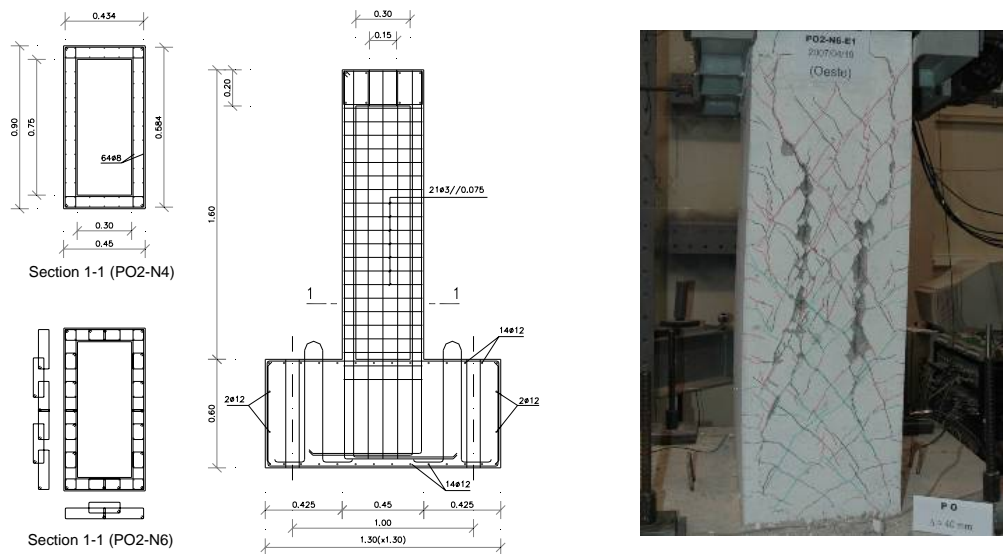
a) Pormenorização da armadura dos pilares e b) Padrão de fendas do pilar PO2-N6.
